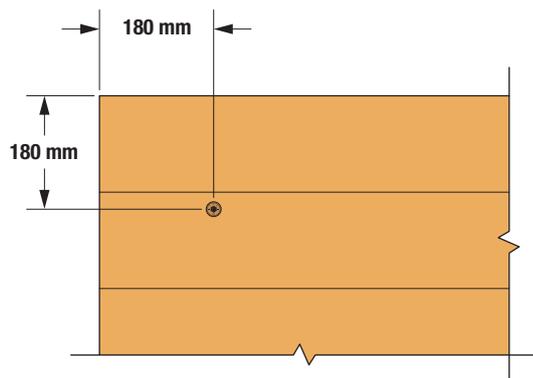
Emplacement de vis pour MTLD dans un panneau CLT avec distance min. d'extrémité = 180 mm, et distance min. de rive = 180 mm.
